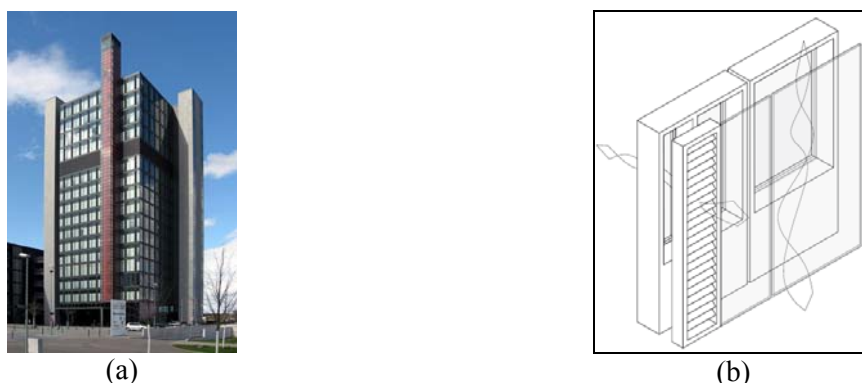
Fachada Alternada, Edifício *Debitel Headquarters*, Stuttgart, RKW Architektur & Städtebau 2002(a), Detalhe do módulo da fachada (b) (Fonte: Knaack et al, 2007).
